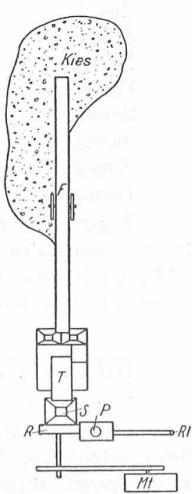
Grundriss der Beton-Pumpenanlage.
